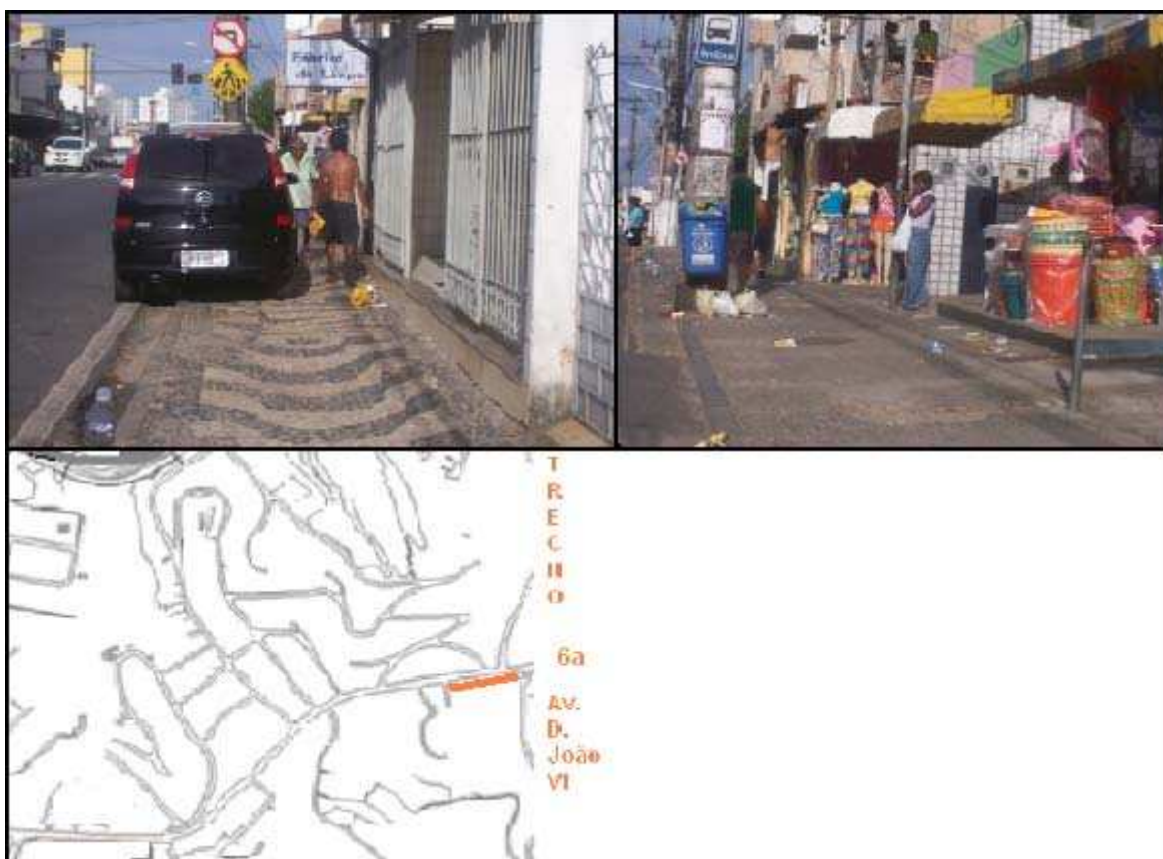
Imagens do trecho “6a” e sua localização no conjunto da área de estudo.
